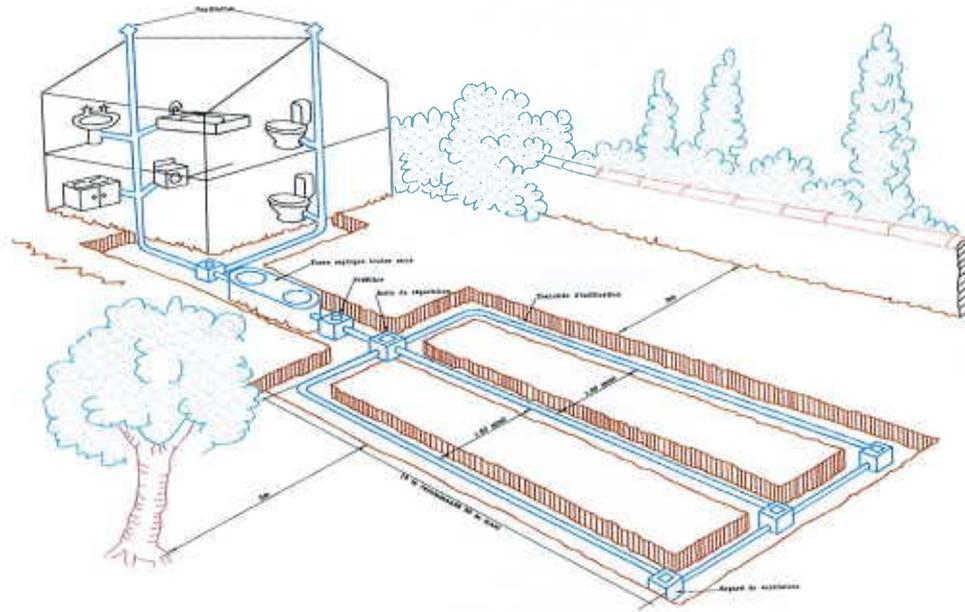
Exemple d'une filière d'assainissement non collectif avec filtre vertical drainé
